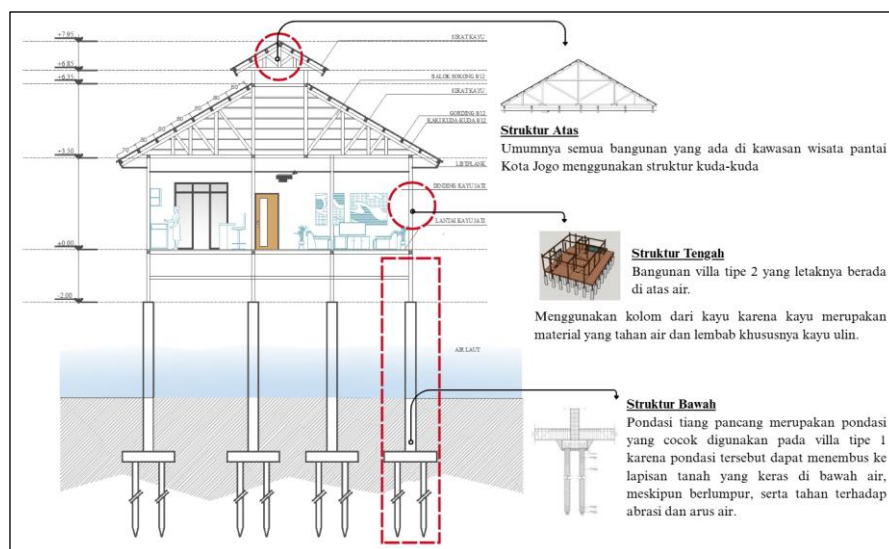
14 Konsep Strukur dan Konstruksi Bangunan Villa Tipe 1
